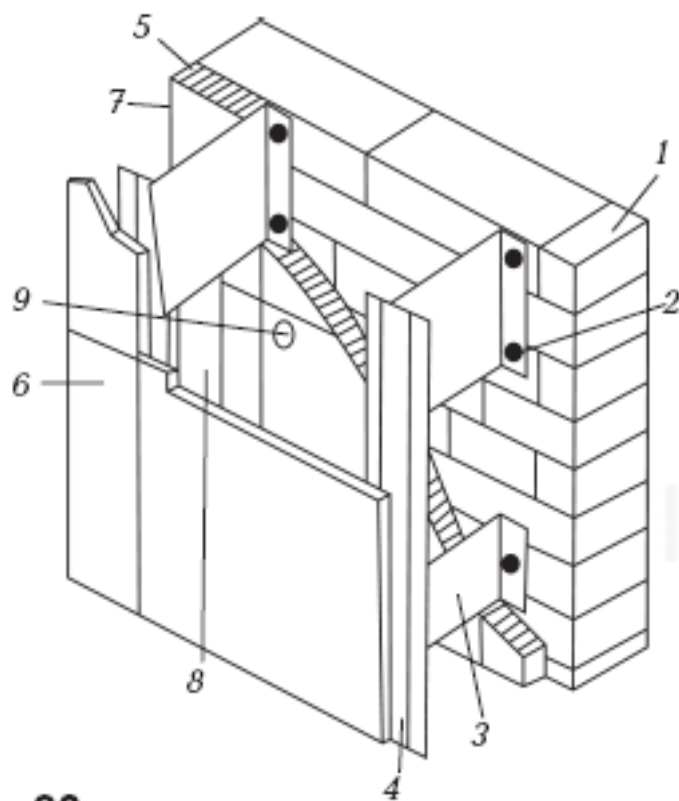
Конструкция навесного вентилируемого фасада на металлическом каркасе: 1 – утепляемая стена; 2 – распорный анкер; 3 – кронштейн; 4 – направляющие; 5 – теплоизоляционные плиты; 6 – плиты защитной декоративной облицовки; 7 – воздушный зазор; 8 – вставка кронштейна; 9 – фасадный дюбель
